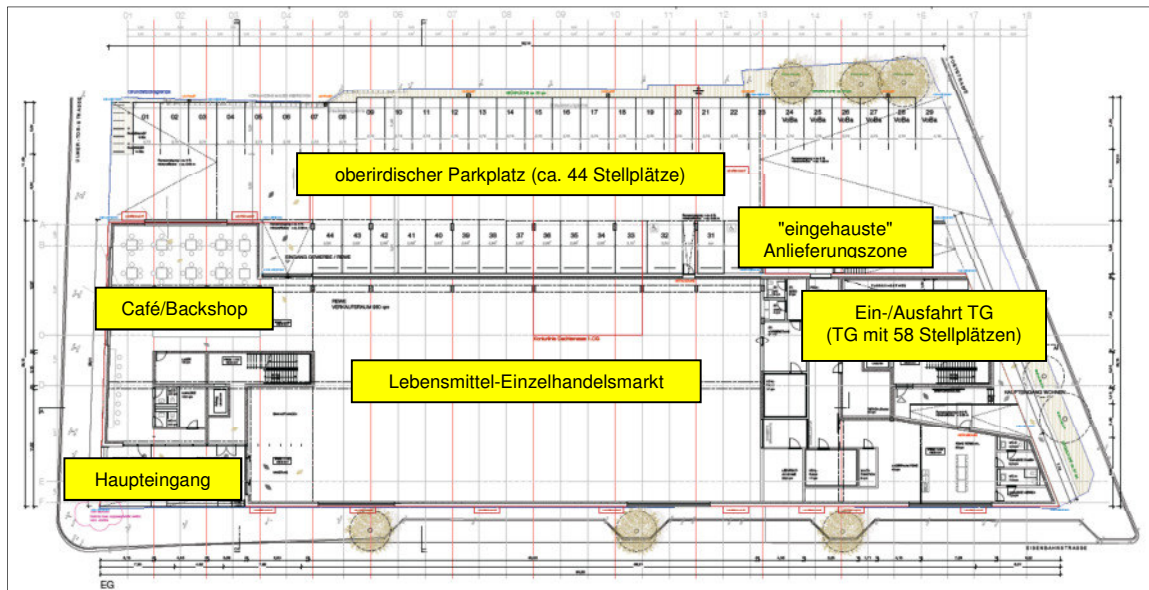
Ausschnitt geplanter Grundriss Erdgeschoss (EG) des Bauvorhabens mit Darstellung der vorgesehenen Gewerbeeinheiten, oberirdischen Pkw-Parkplätze sowie Ein-/Ausfahrt Tiefgarage gemäß [c]
